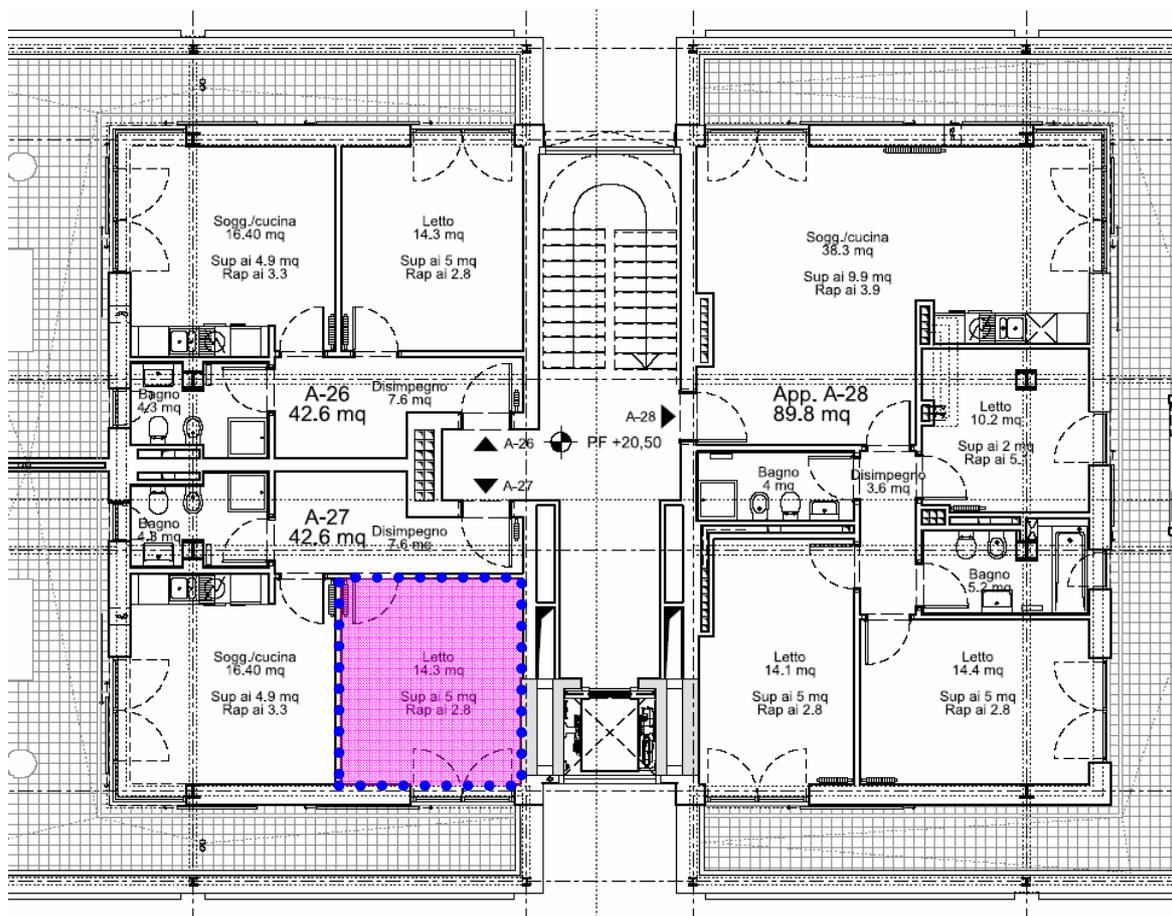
Indicazione della porzione di solaio oggetto di verifica (piano attico)
